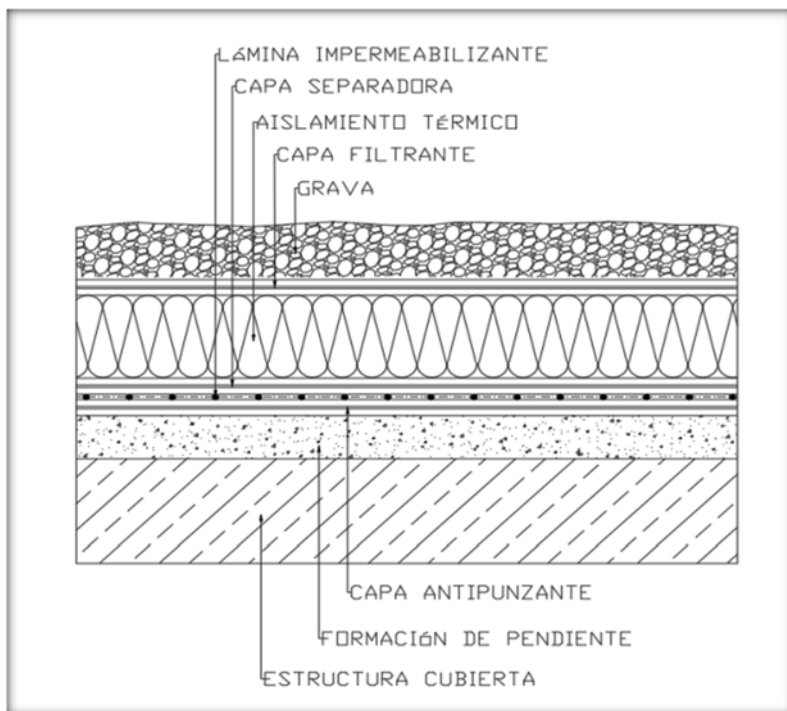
Detalle Constructivo Cubierta Plana Invertida No Transitable
